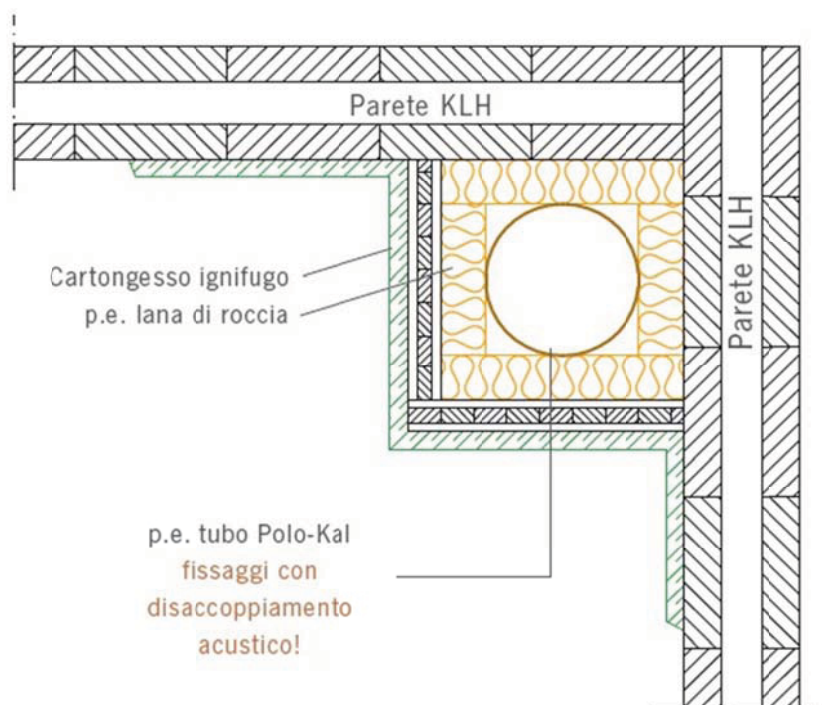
Schema in pianta: cavedio impiantistico.
